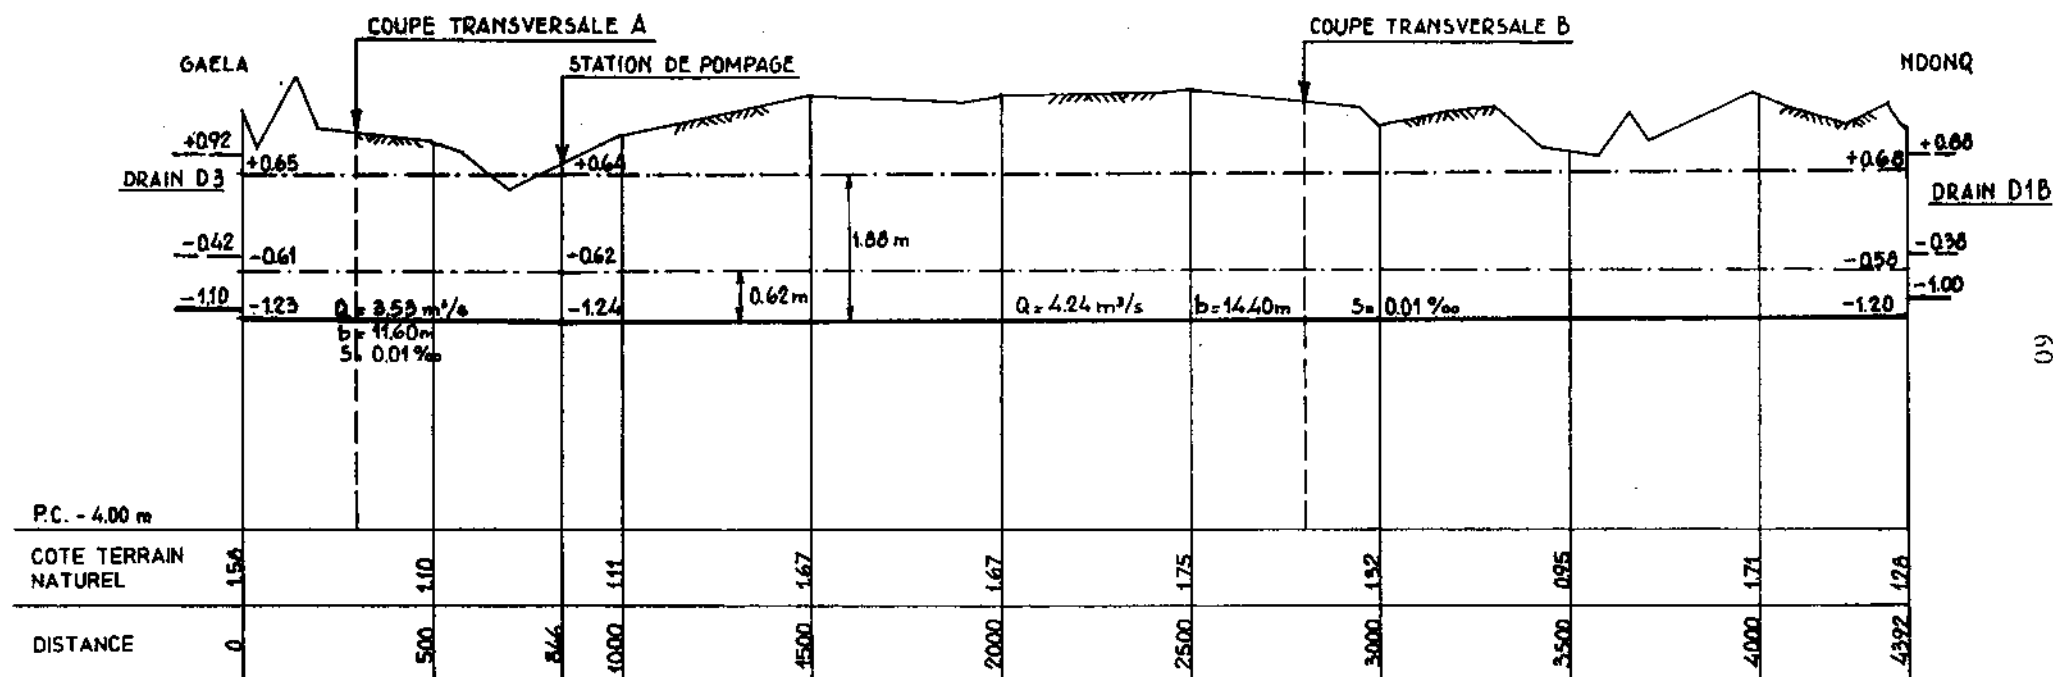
<sup>A</sup> DRAIN DE CONNEXION PROJETE , PROFIL LONGITUDINAL : CAS DES POMPES STANDARD
